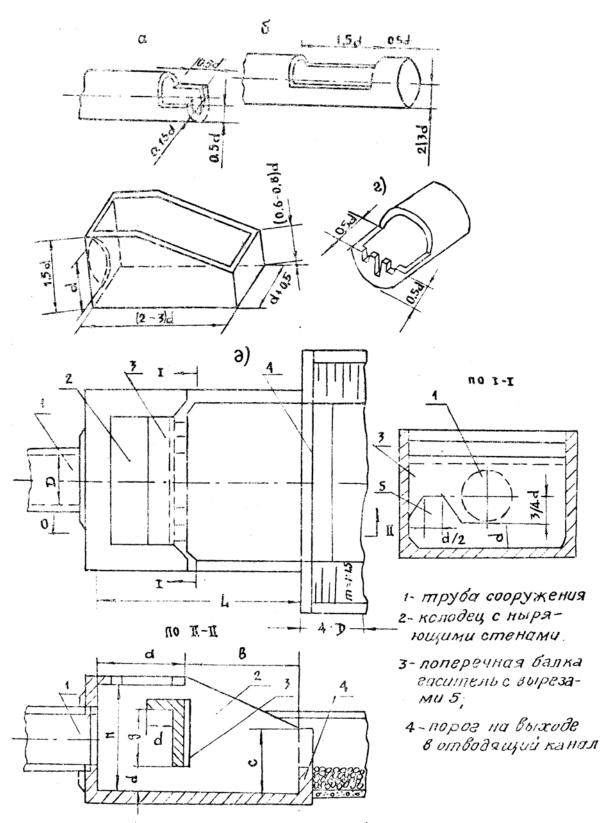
Гасители энергии для трубчатых сооружений: а – гаситель САНИИРИ; б – трубчатый гаситель ВНИИГиМа; в – коробчатый гаситель Средазгипроводхоза; г – гаситель УкрНИИГиМа; д – коробчатый гаситель США
